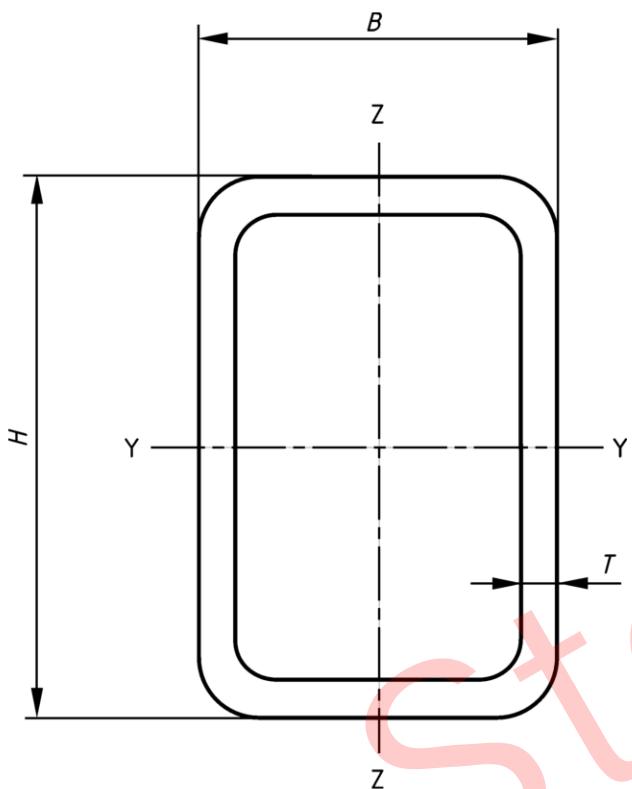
Hohlprofil mit rechteckigem Querschnitt
